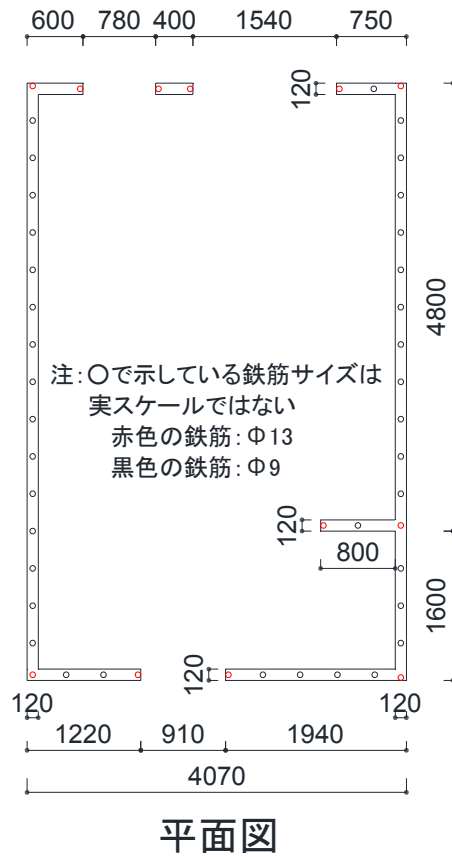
漁民住宅 1 ユニット分平面図 (単位: mm)
